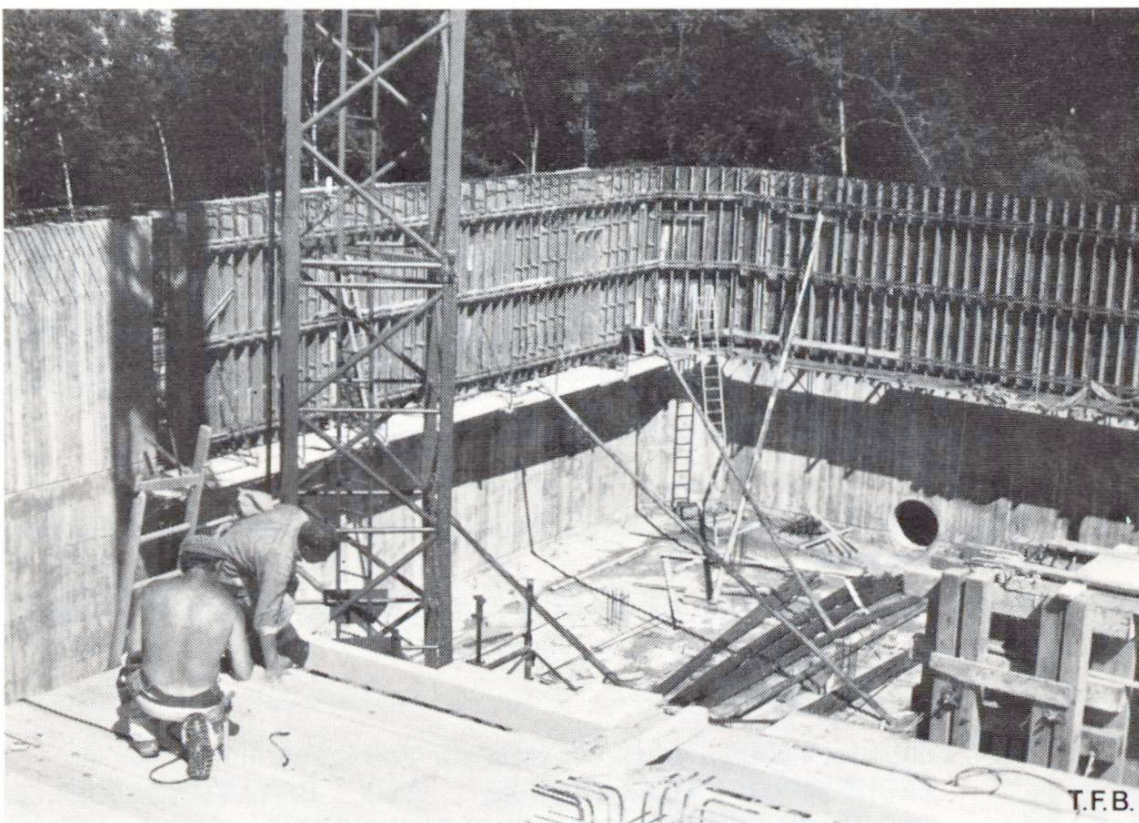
Betonierung eines Wandabschnittes in Grosstafelschalungen.
